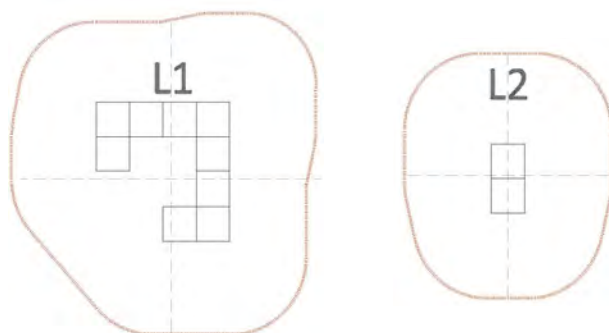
Dibujo en planta de dos tipos de elementos de juego simbólico.
